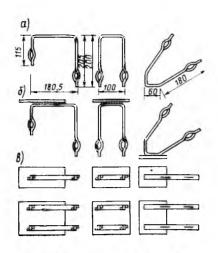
Конструкции крепежных штампосварных закладных деталей с унифицированными анкерами а — заготовка анкера; б — формы полосовых анкеров; в — конструктивные схемы деталей
